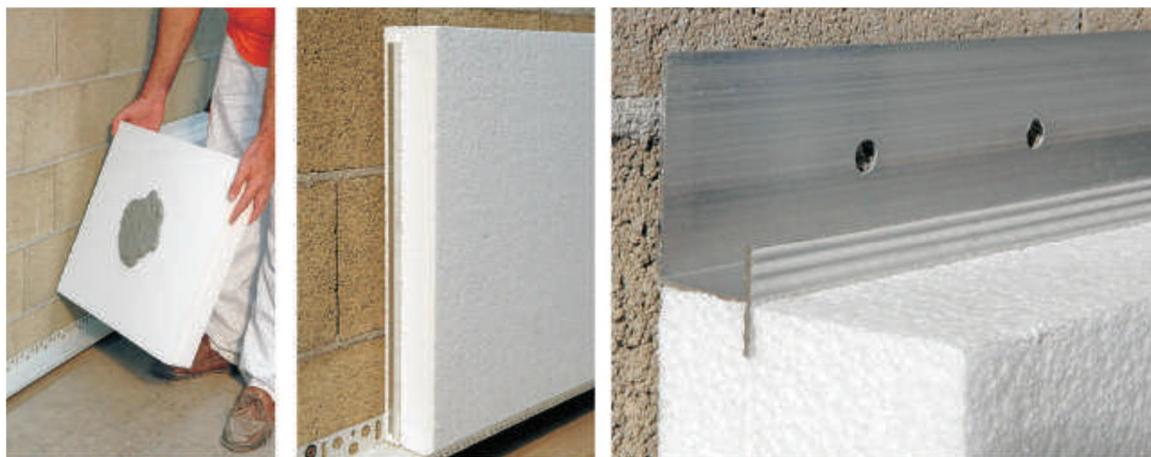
Installazione dei profili metallici (da: Manuale di posa Waler 2016)
